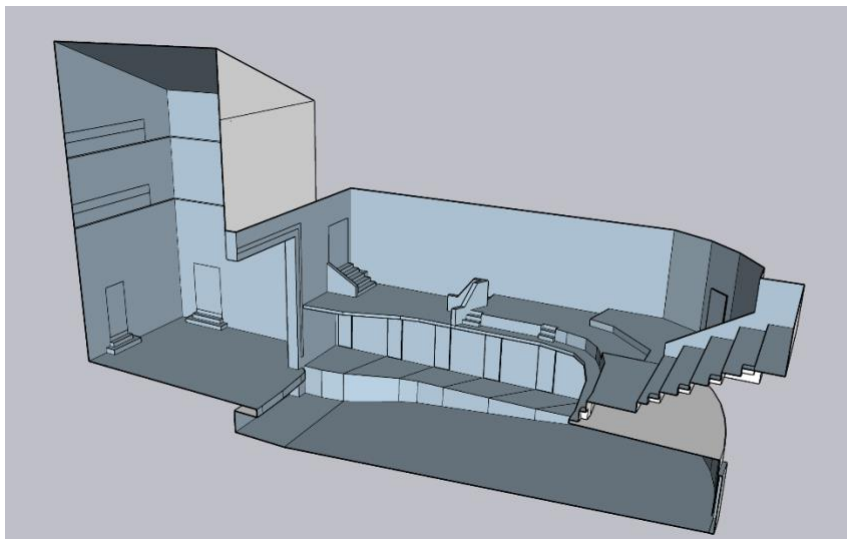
Modelado planta superior y paredes de caja escénica.
